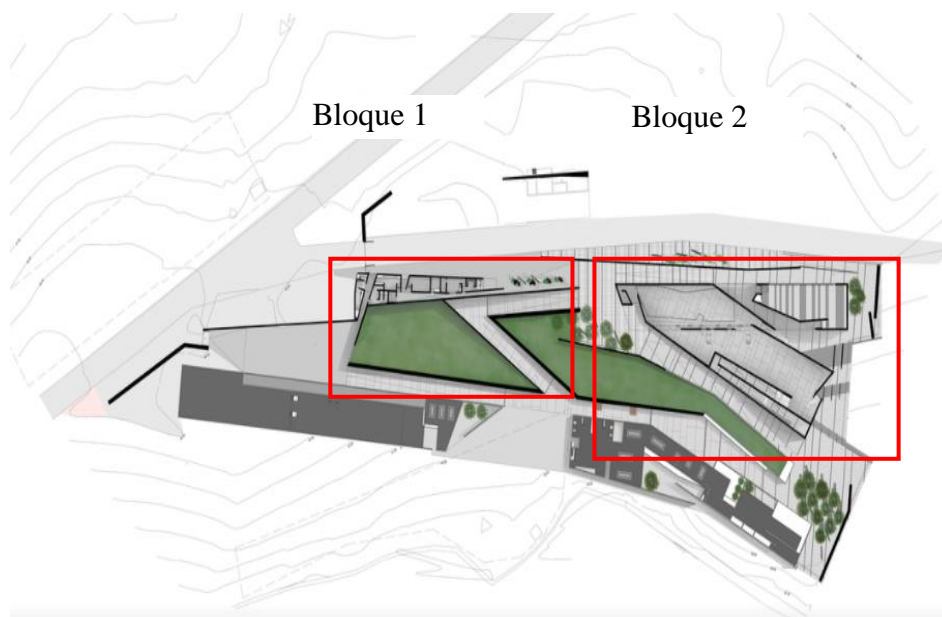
Conformación de bloques de la propuesta arquitectónica en planta.
